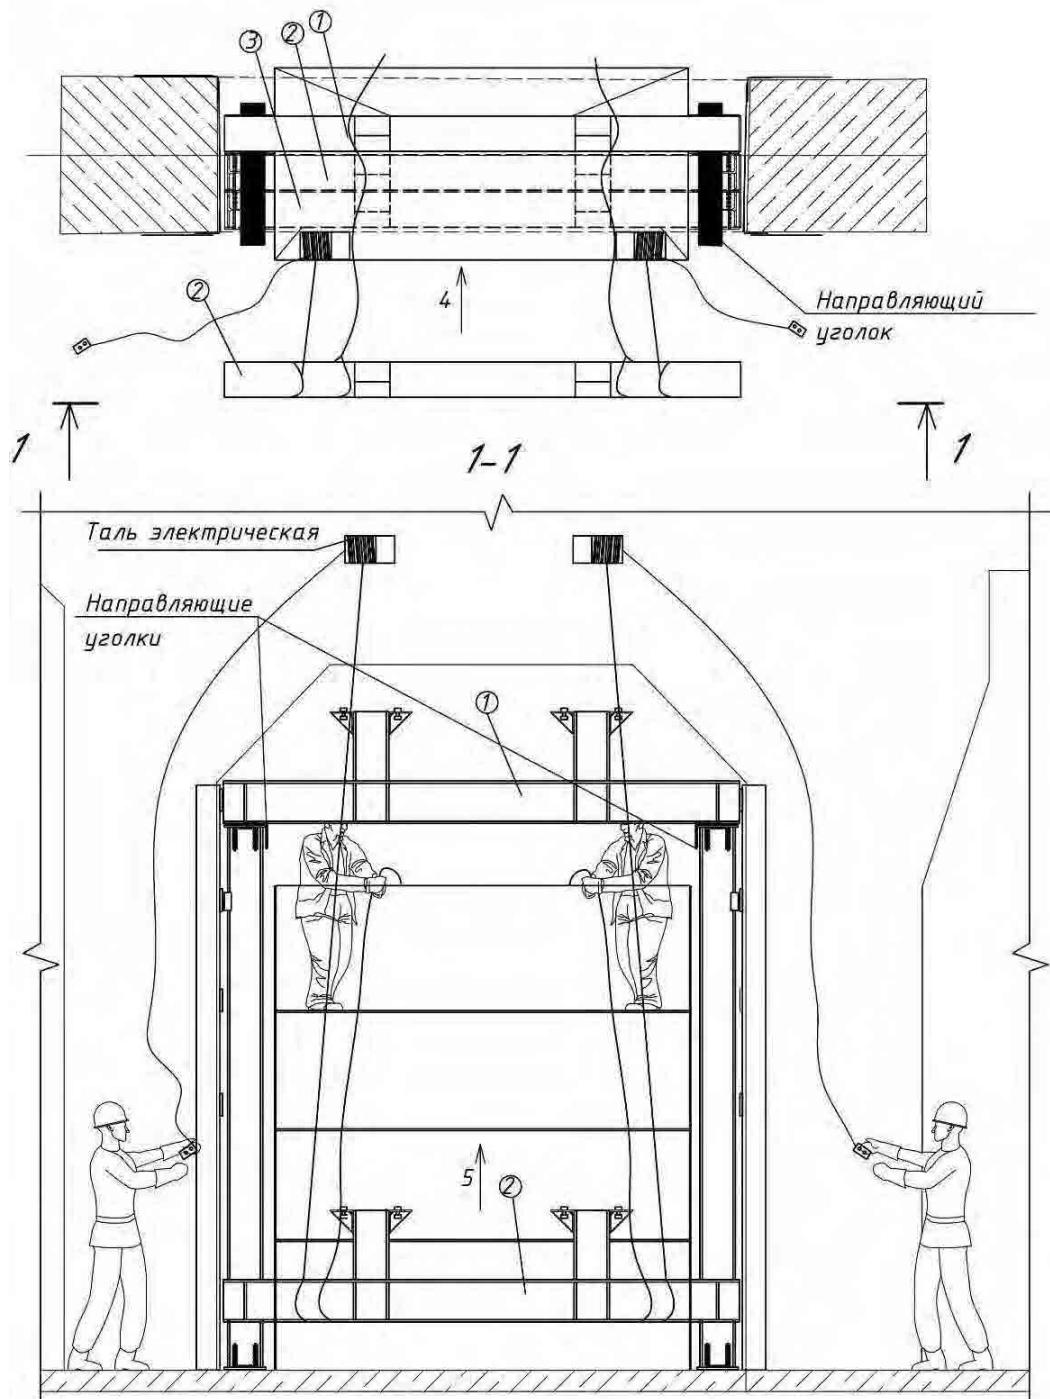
Схема монтажа горизонтальних балок (1 уровень) способом надвижки их на соответствующие стойки: 1 – первая установленная балка; 2 – вторая балка во время монтажа и ее монтажное место; 3 – место установки третьей балки; 4 – направление надвижки; 5 – направление монтажа
